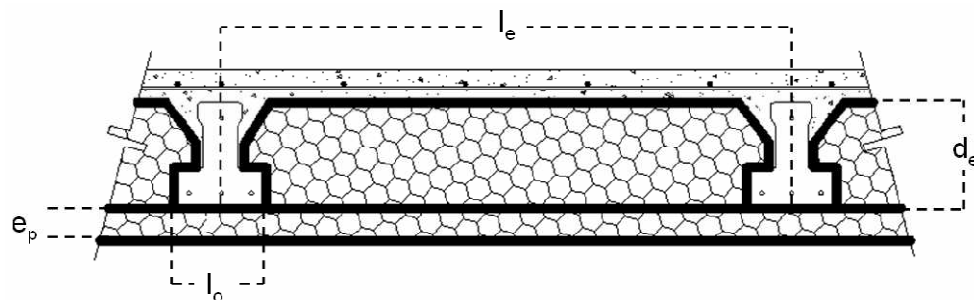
Aislamiento Inferior Continuo (A.I.C)
